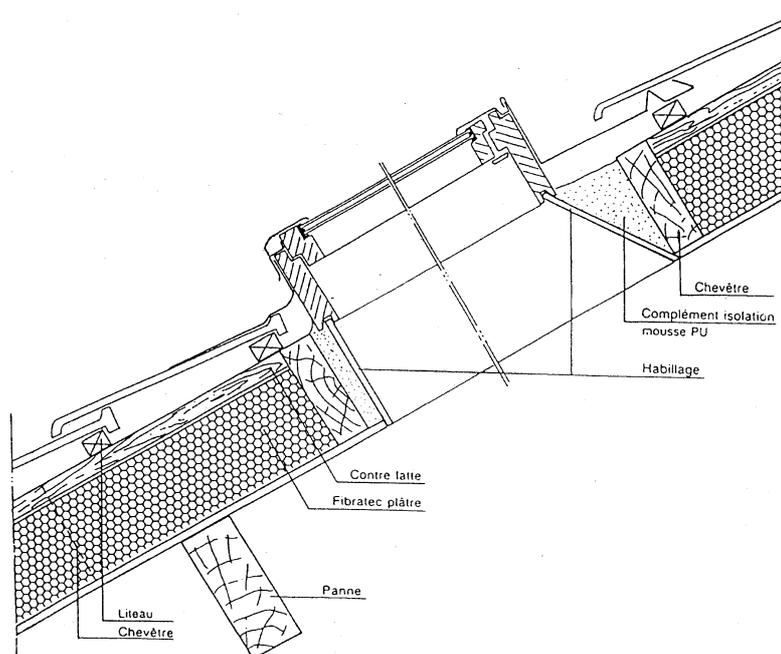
Détail de mise en œuvre de fenêtre pour toit en pente (coupe verticale)
